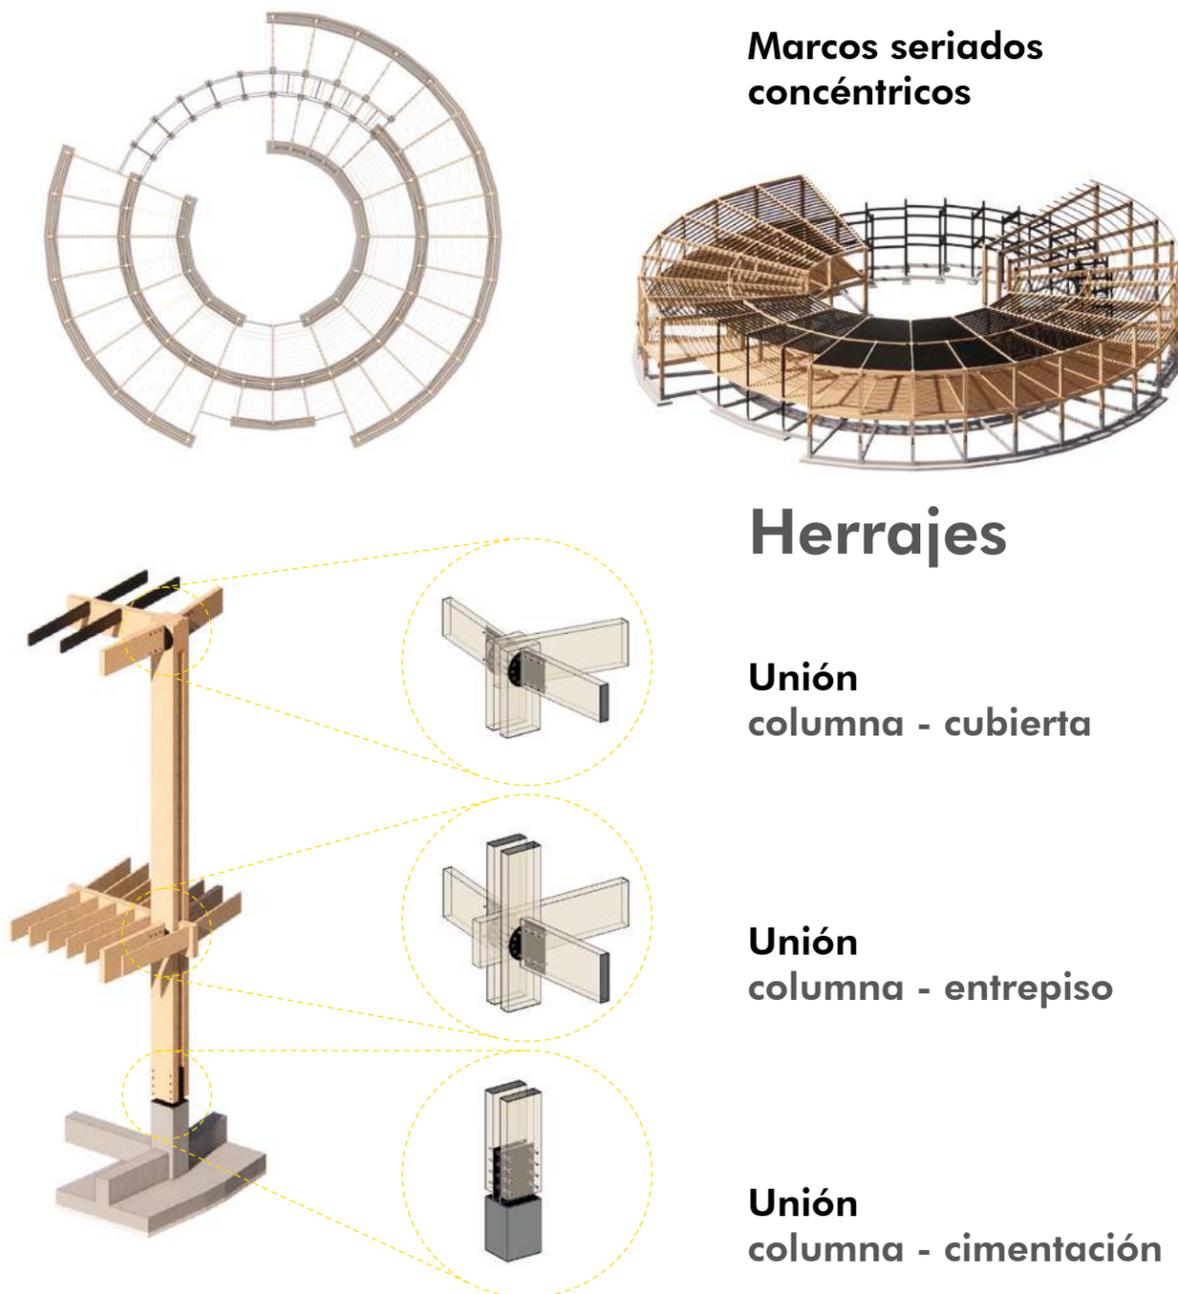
Detalles estructurales del SMART E-Lab. Fuente: Elaboración propia.
